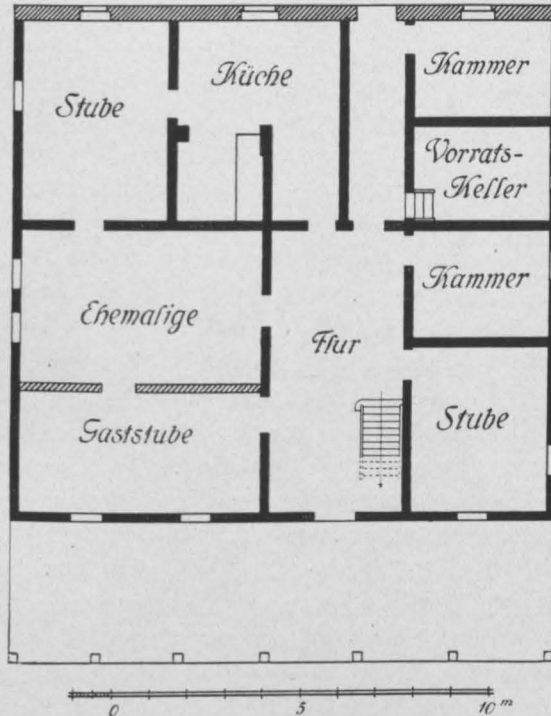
Pillgram. Bauernhaus, Grundriß.
